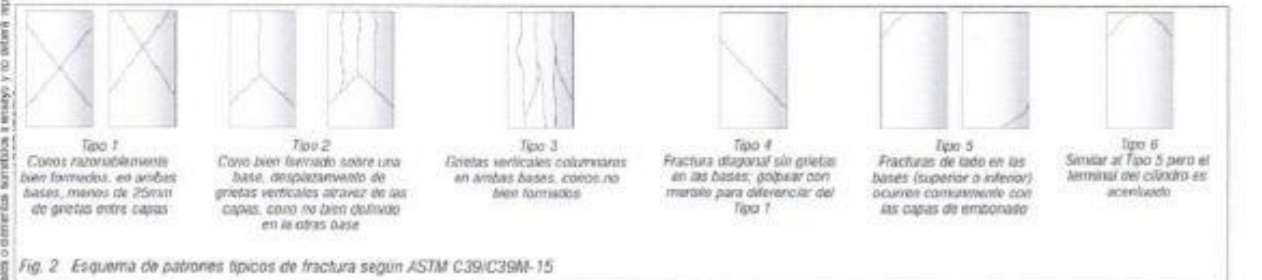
Esquema de patrones típicos de fractura según ASTM C39/C39M-20
